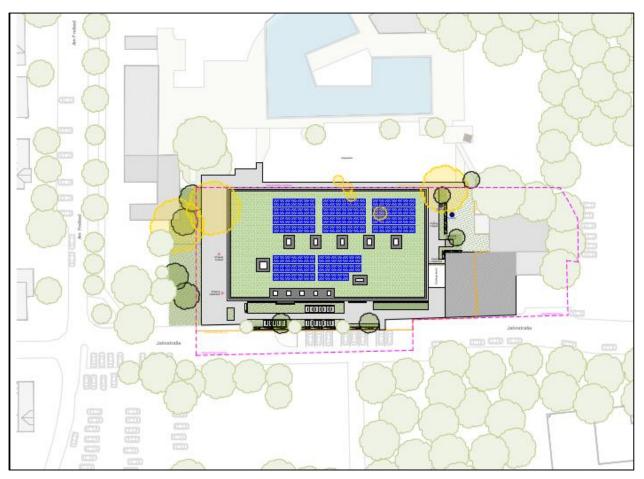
Lageplan des Vorhabens [Quelle: Stadt Ennigerloh, Stand: 12.03.2024]
